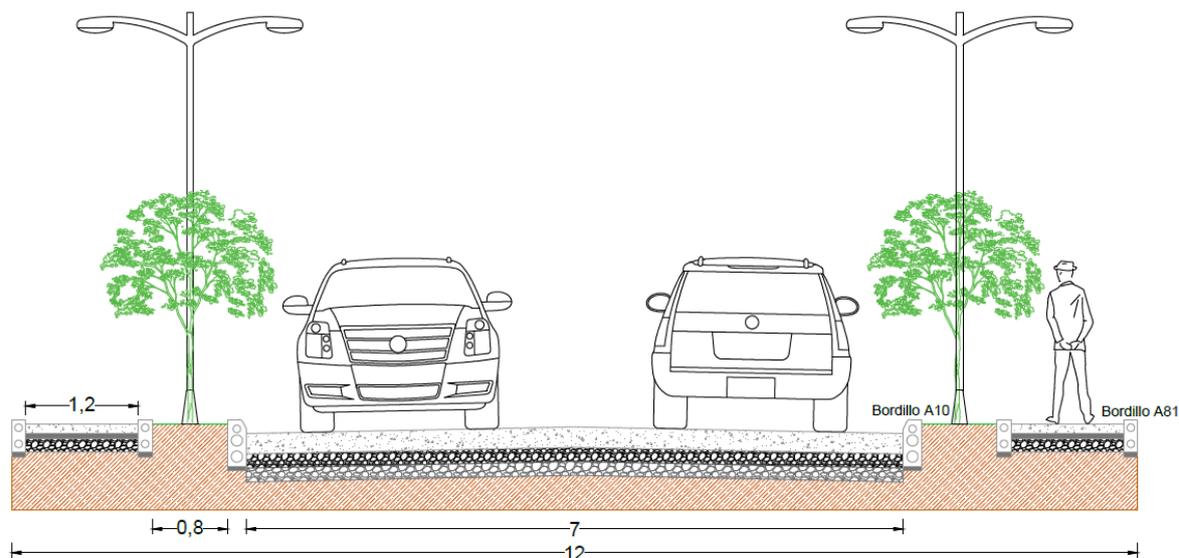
Detalle de la Sección Transversal de la vía completa. Elaboración Propia
